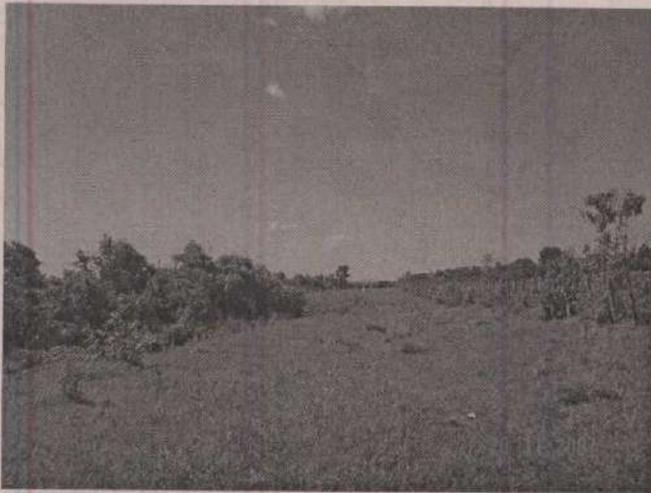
Vista da área onde se pretende implantar a cabeceira da ponte (Alternativa 1).
